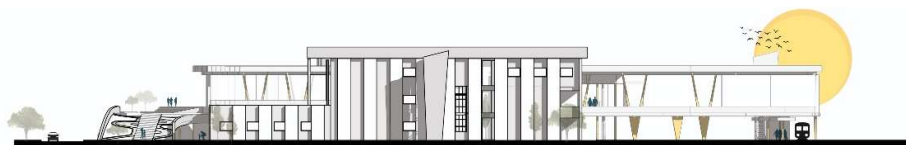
Fachada Norte. Elaborado por Kevin J. Enríquez
